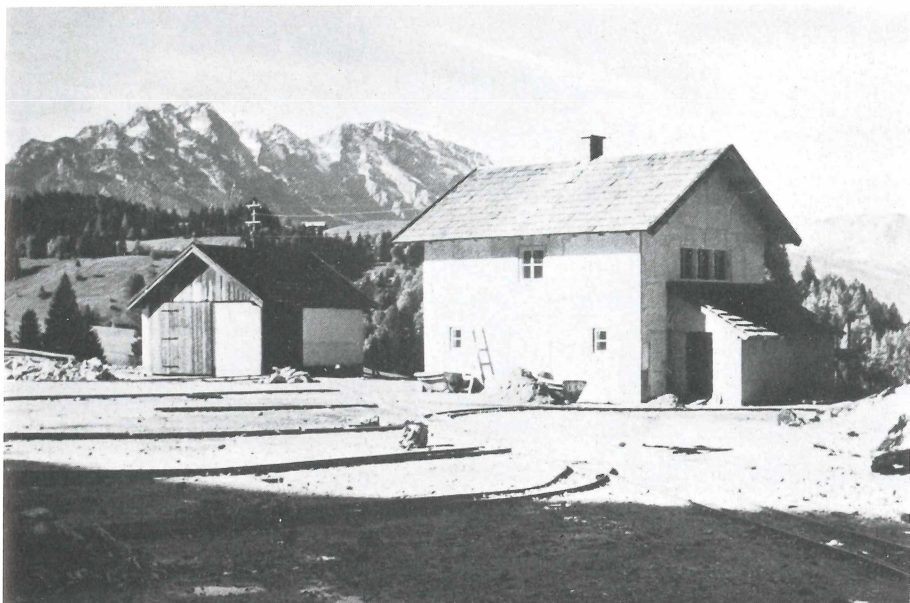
Gipssteinbruch Moosegg. Steinbrecherhütte mit Werkzeugschuppen, errichtet 1920, abgetragen 1955/56. (Moldan)
